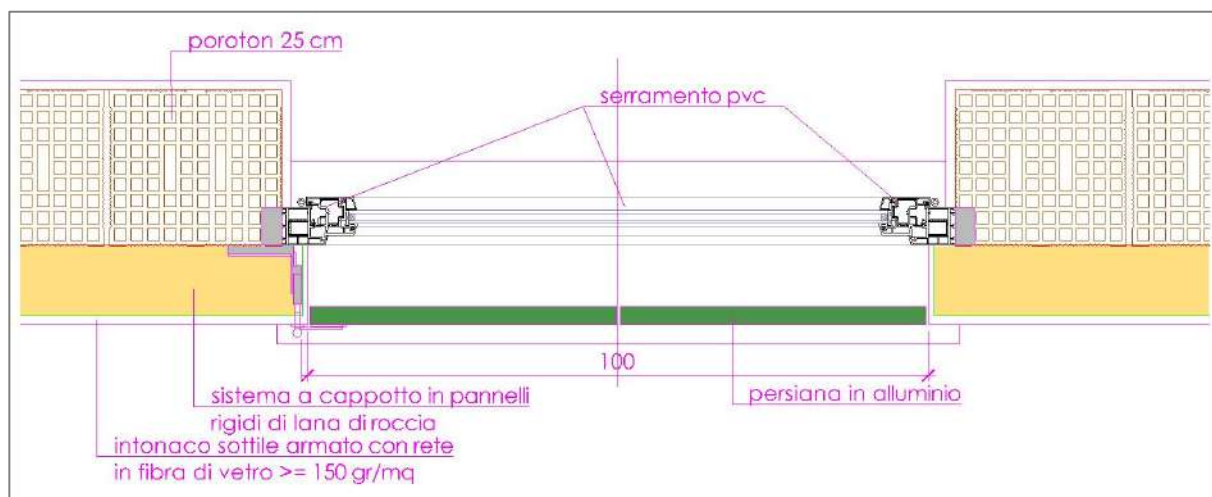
Sezione schematica del serramento e della parete perimetrale delle nuove opere.
